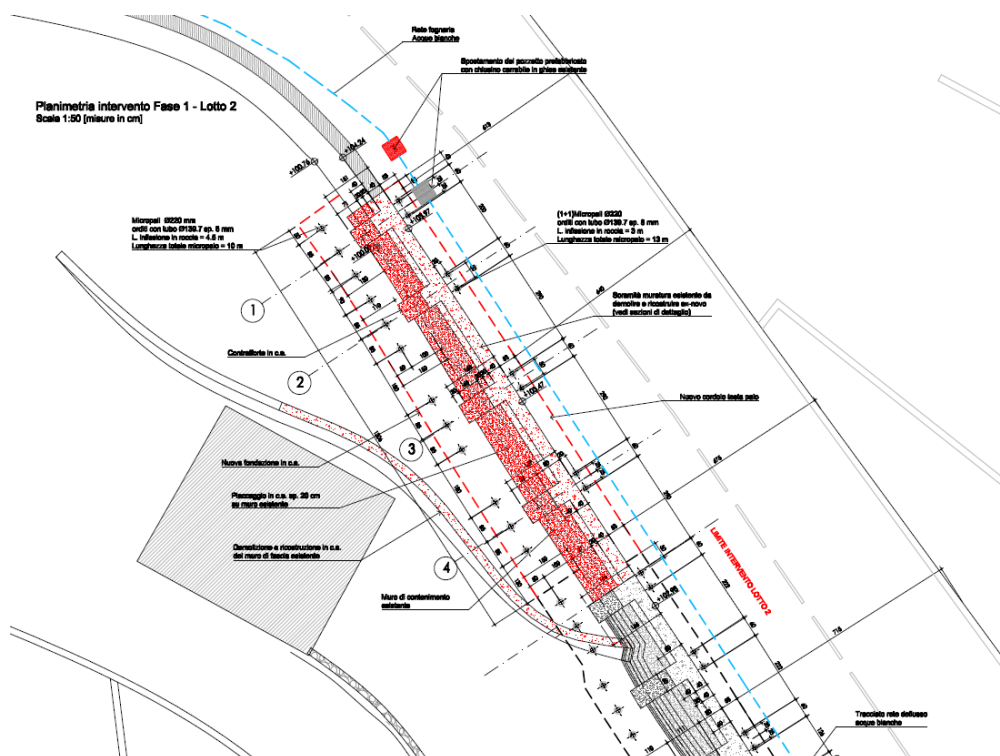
Planimetria intervento Lotto 2 – Fase 1
